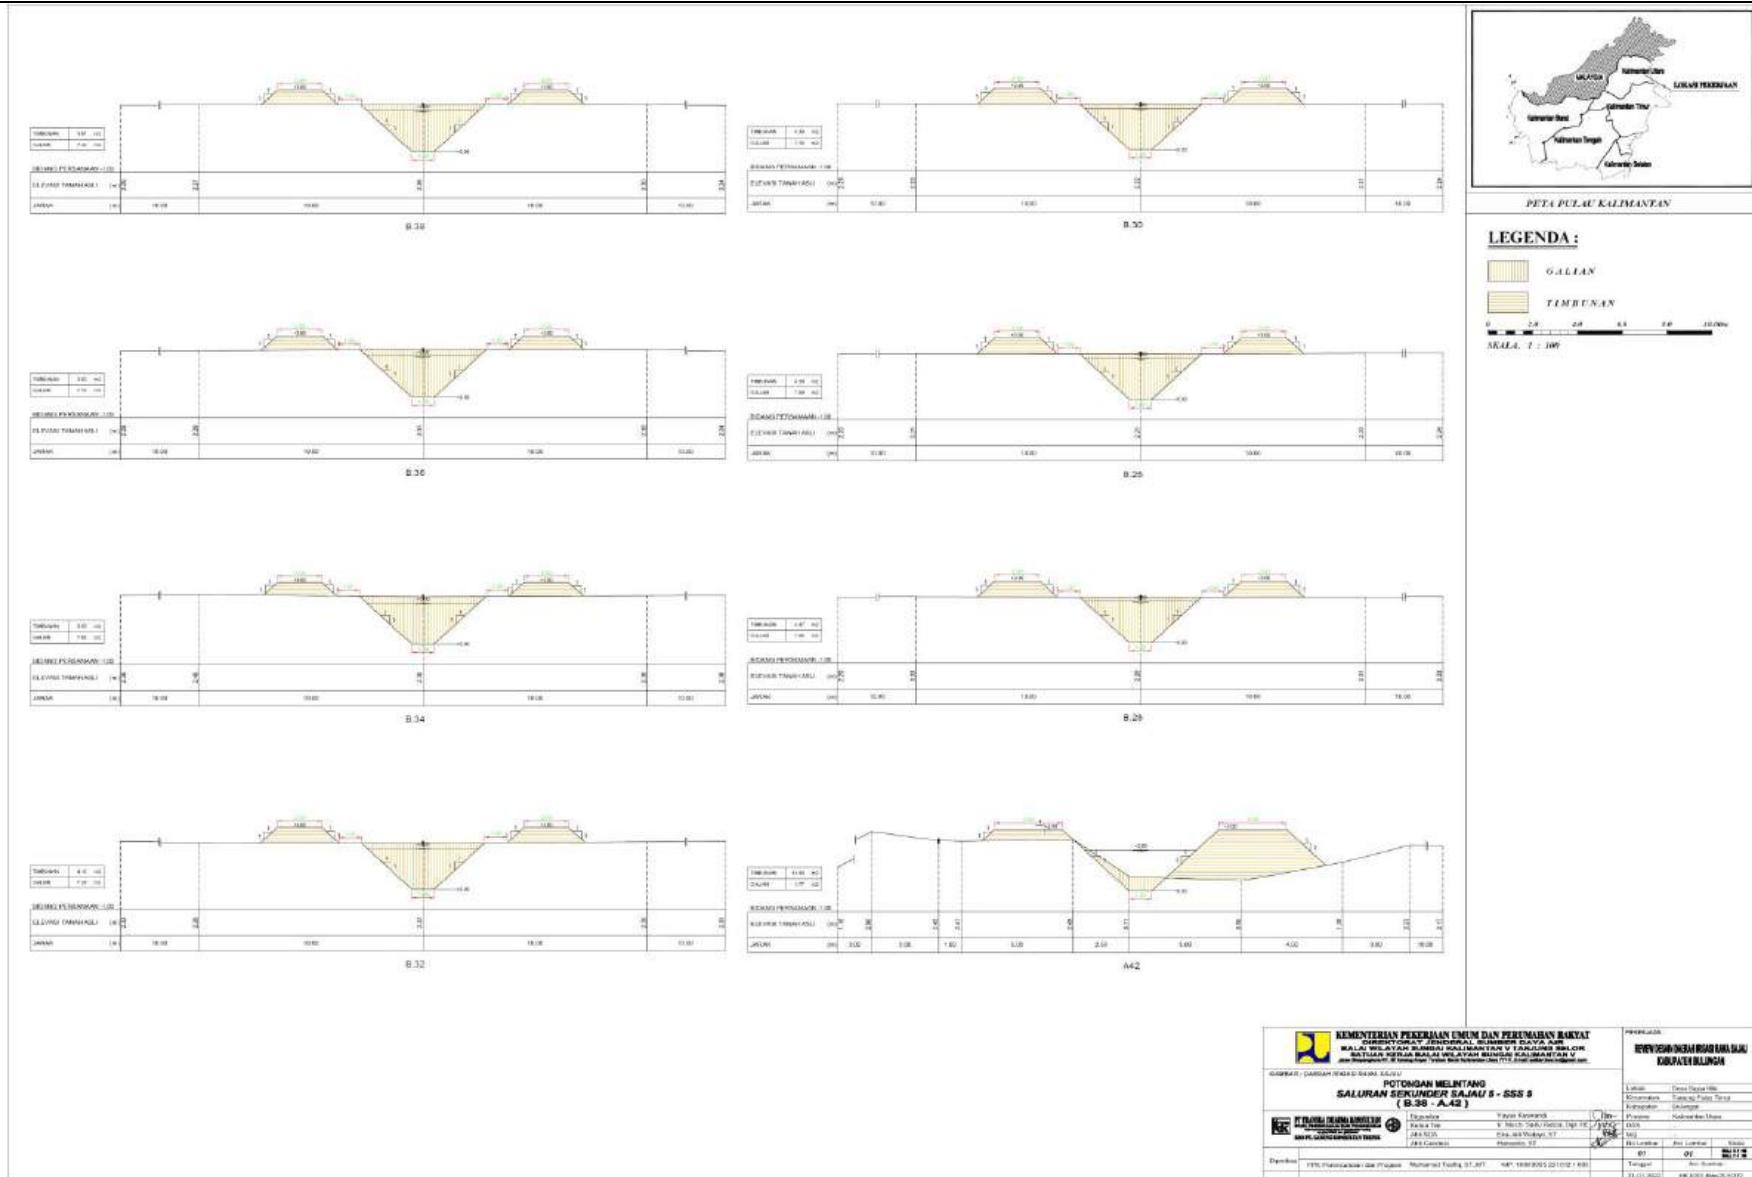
Contoh Profil Melintang Pada Saluran Eksisting pada Blok Sajau
